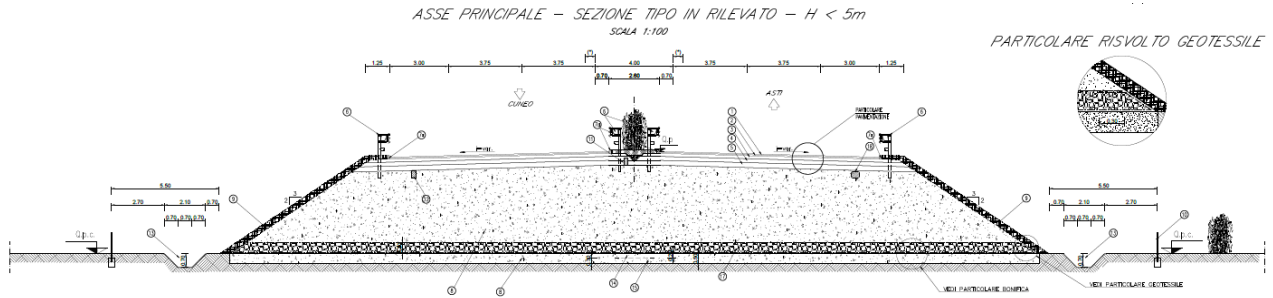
Asse principale: Sezione tipo in rilevato – $H < 5m$
